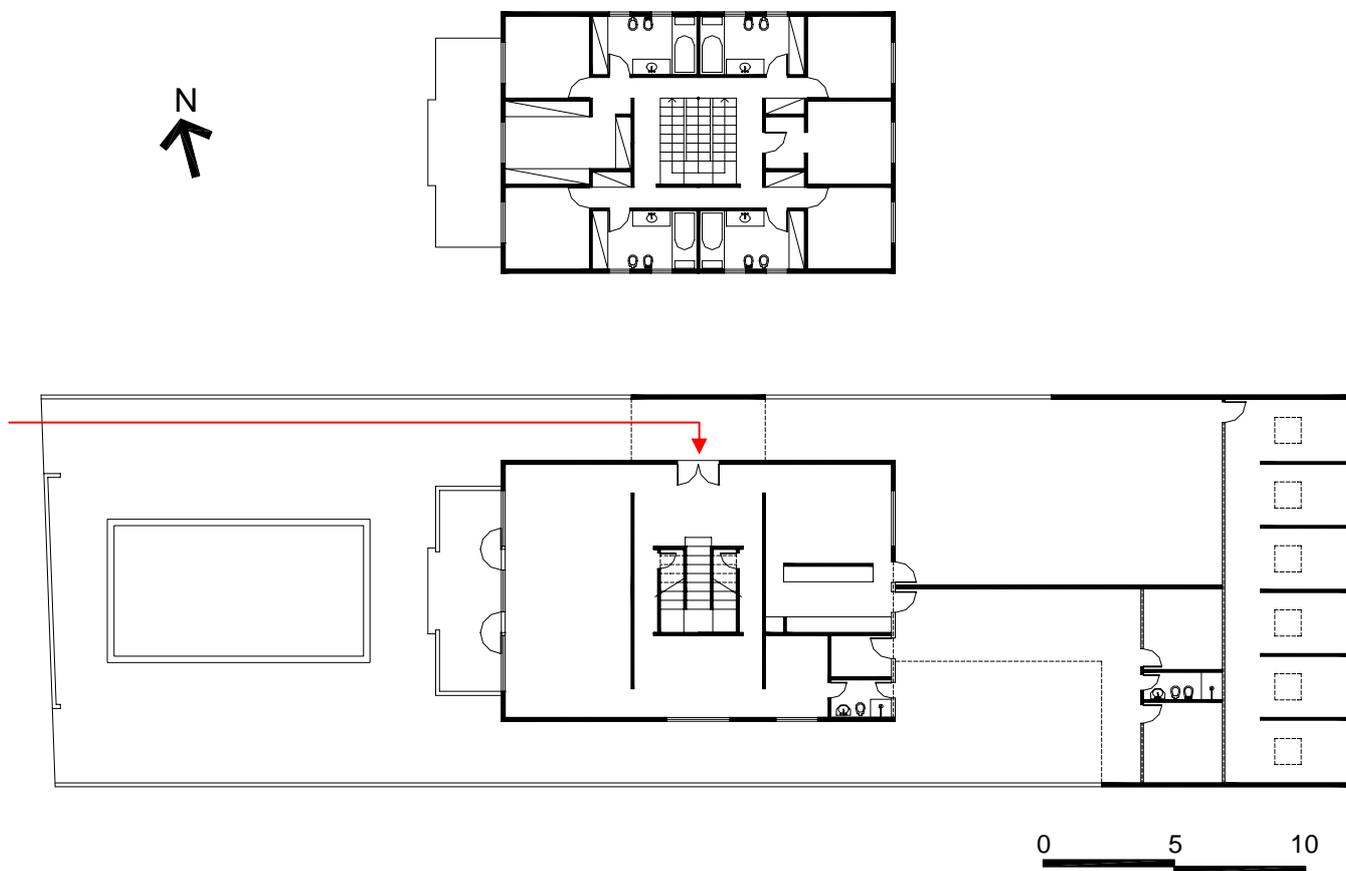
e 41: Plantas da Casa do Arquiteto, na Barra da Tijuca – Rua Prudência do Amaral. De baixo para cima: Pavimento térreo e pavimento superior. (Desenhos da autora, a partir de plantas do acervo da “Coleção Bolonha” - NPD/FAU/UFRJ).
